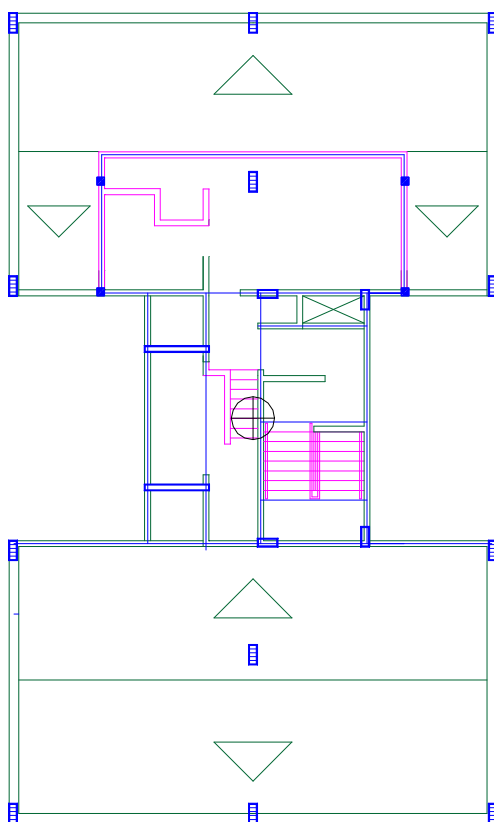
Edifício Exemplo: Forma estrutural para o Pavimento Ático
